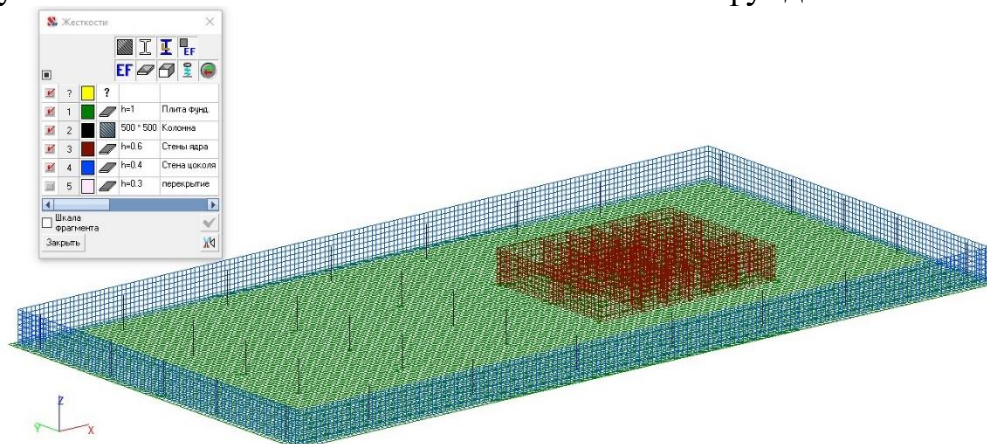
Конечно элементная схема фундаментной плиты
